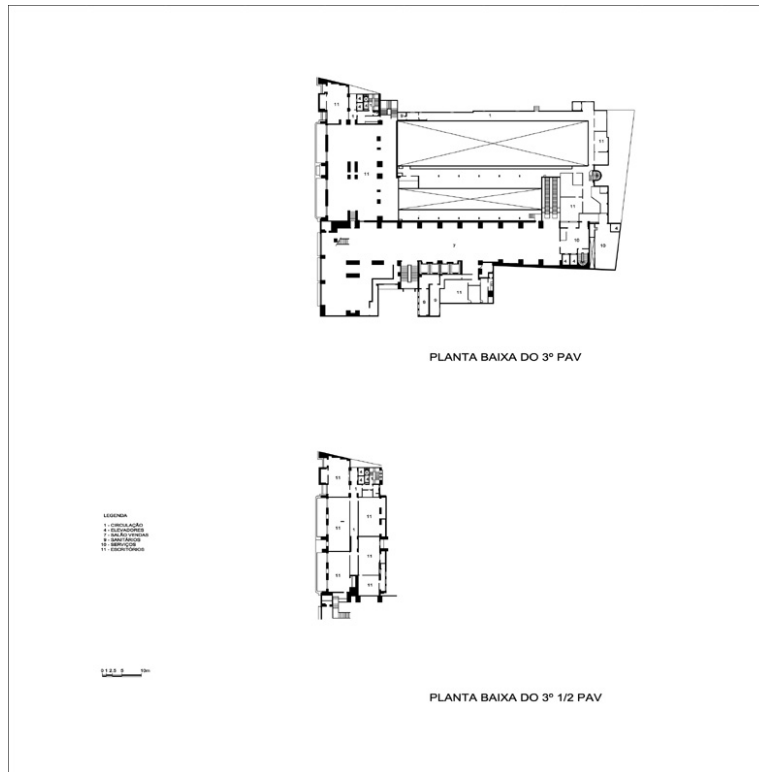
Planta baixa do 3º pavimento e do 3º ½ pavimento
